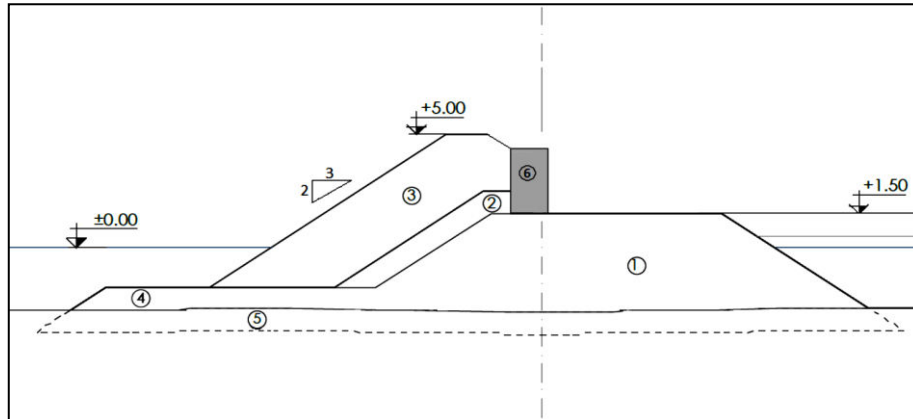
Coupes type au niveau du profil d'enracinement de la digue.
